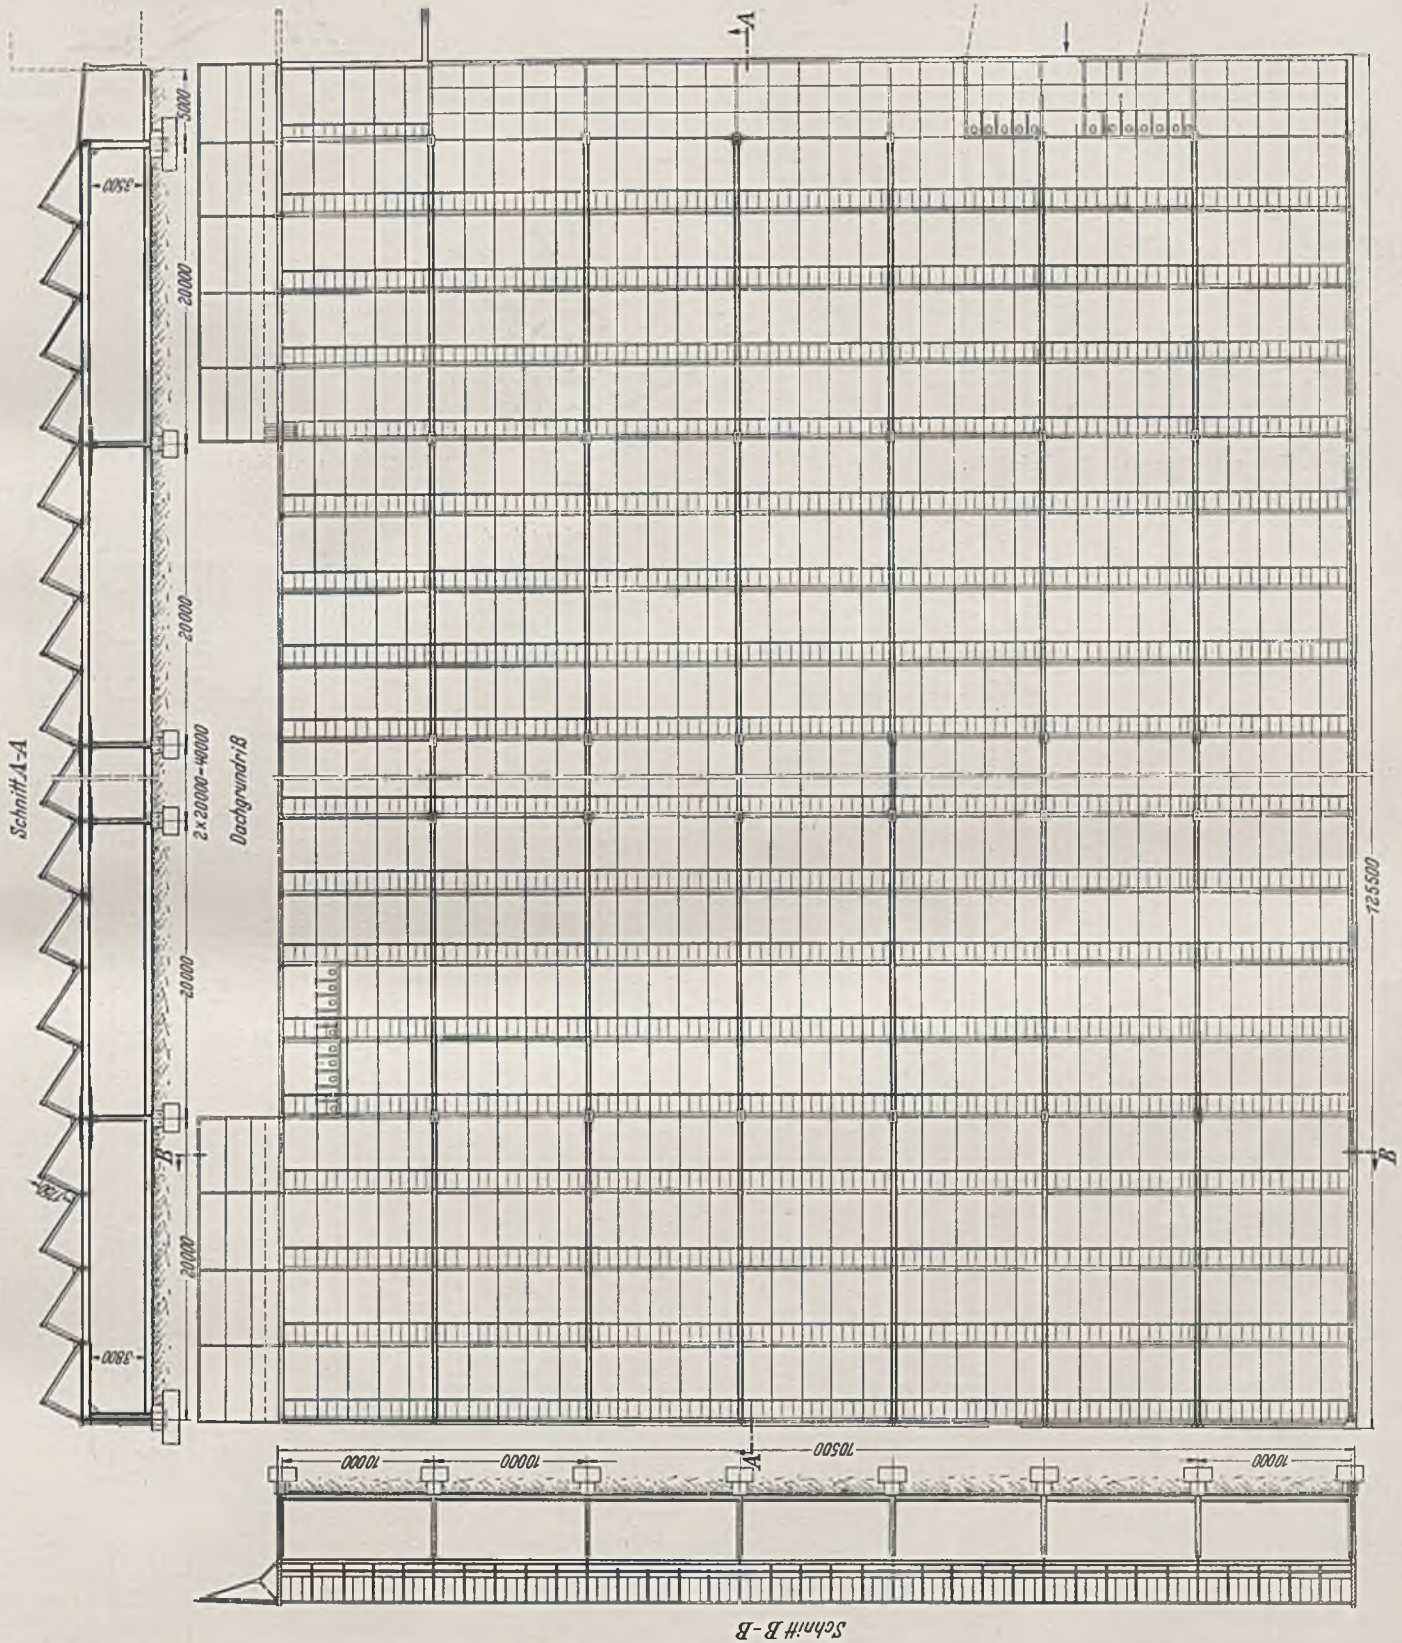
Bau 2: Grundriß, Quer- und Längsschnitt.
